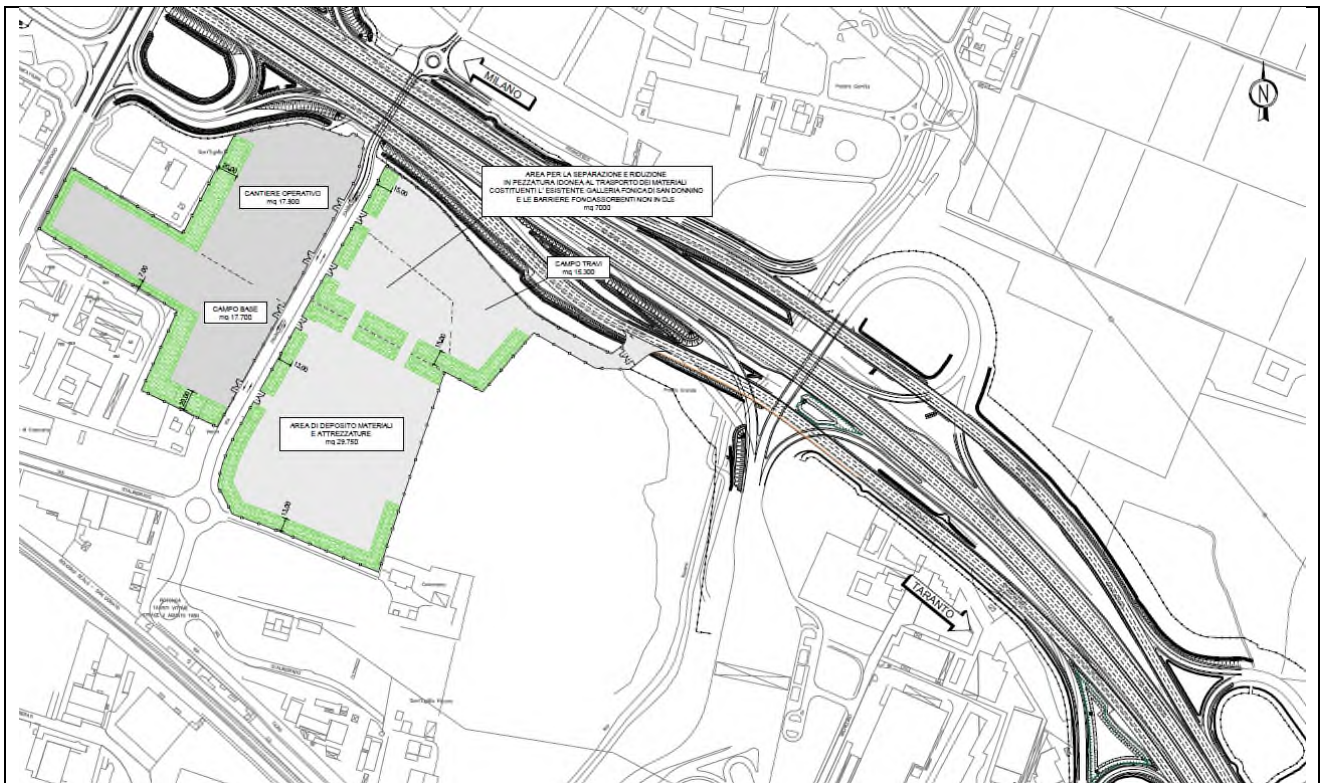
Cantiere area Fiera – Progetto Definitivo approvato
